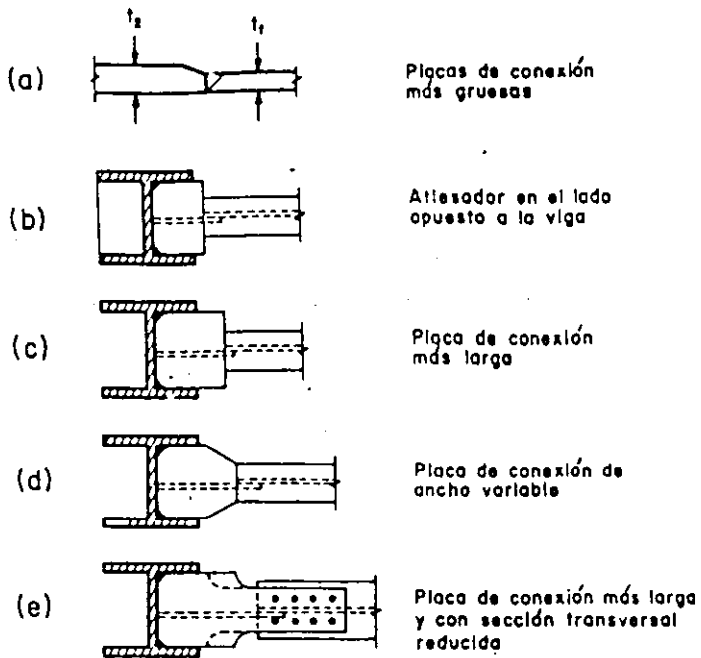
Medidas para mejorar el comportamiento de juntas con vigas unidas al alma de la columna
